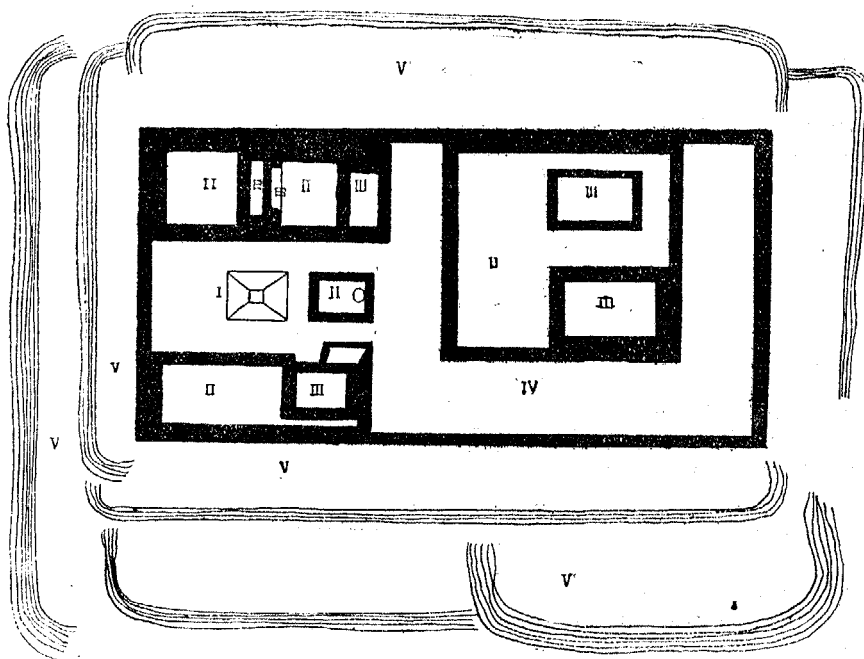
A. Esquema de las construcciones en Yatachío, Tamazulapan, Oax.
